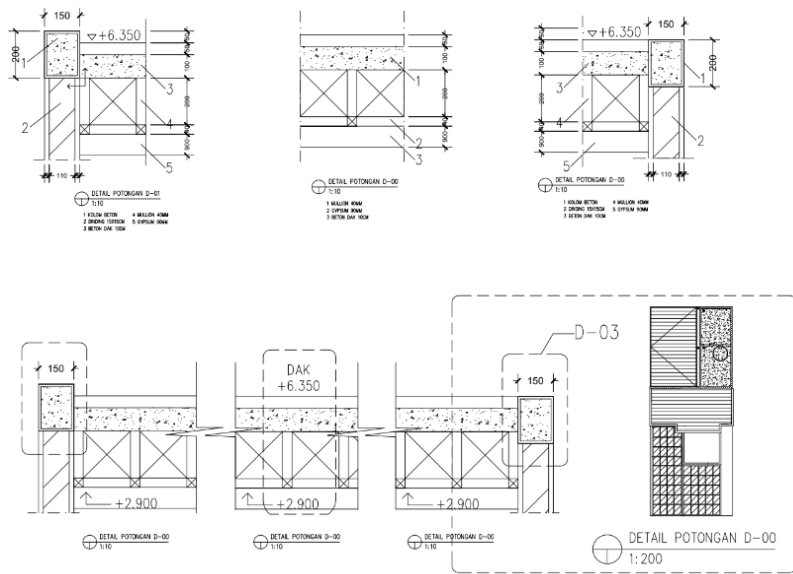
Pendetailan denah perencanaan dan eksisting
